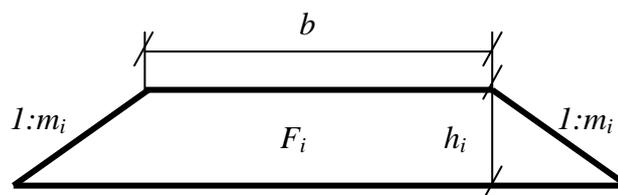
Элементы поперечного сечения насыпи
